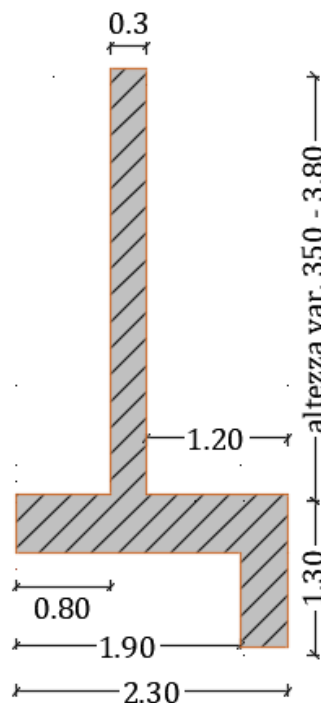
Sezione tipo nuove arginature Fiumara Armo
